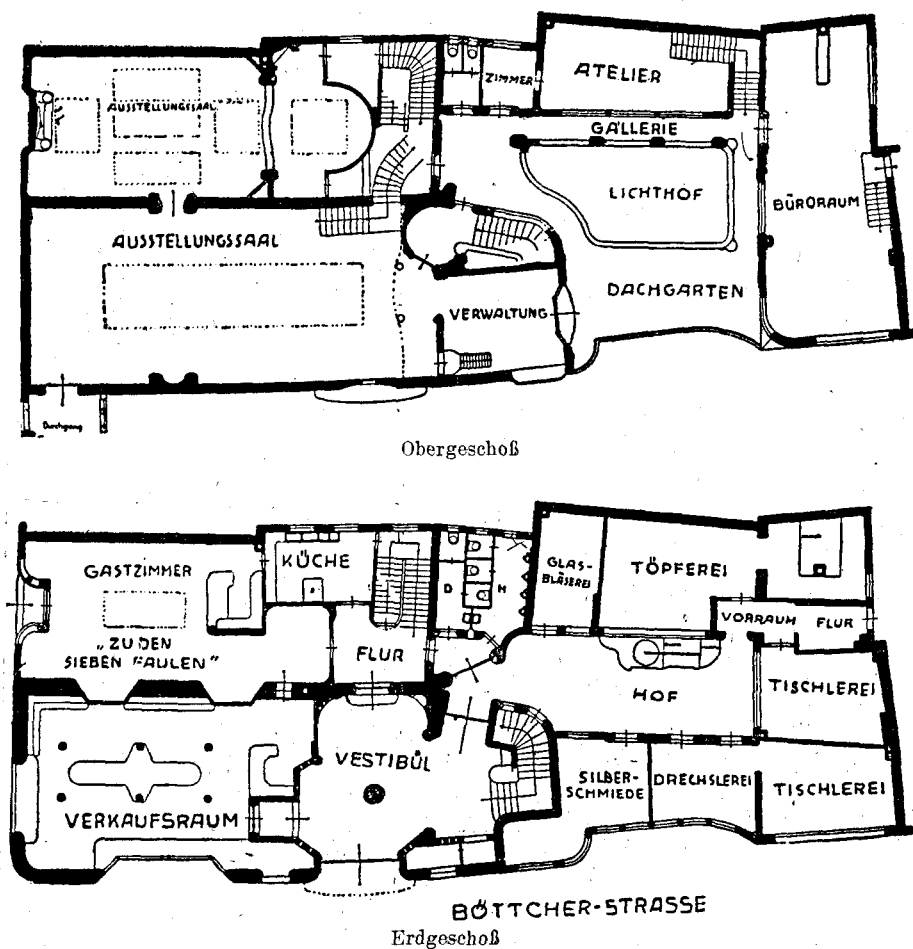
und 11 — Erdgeschoß und Obergeschoßgrundriß des Paula-Becker-Modersohn-Hauses
